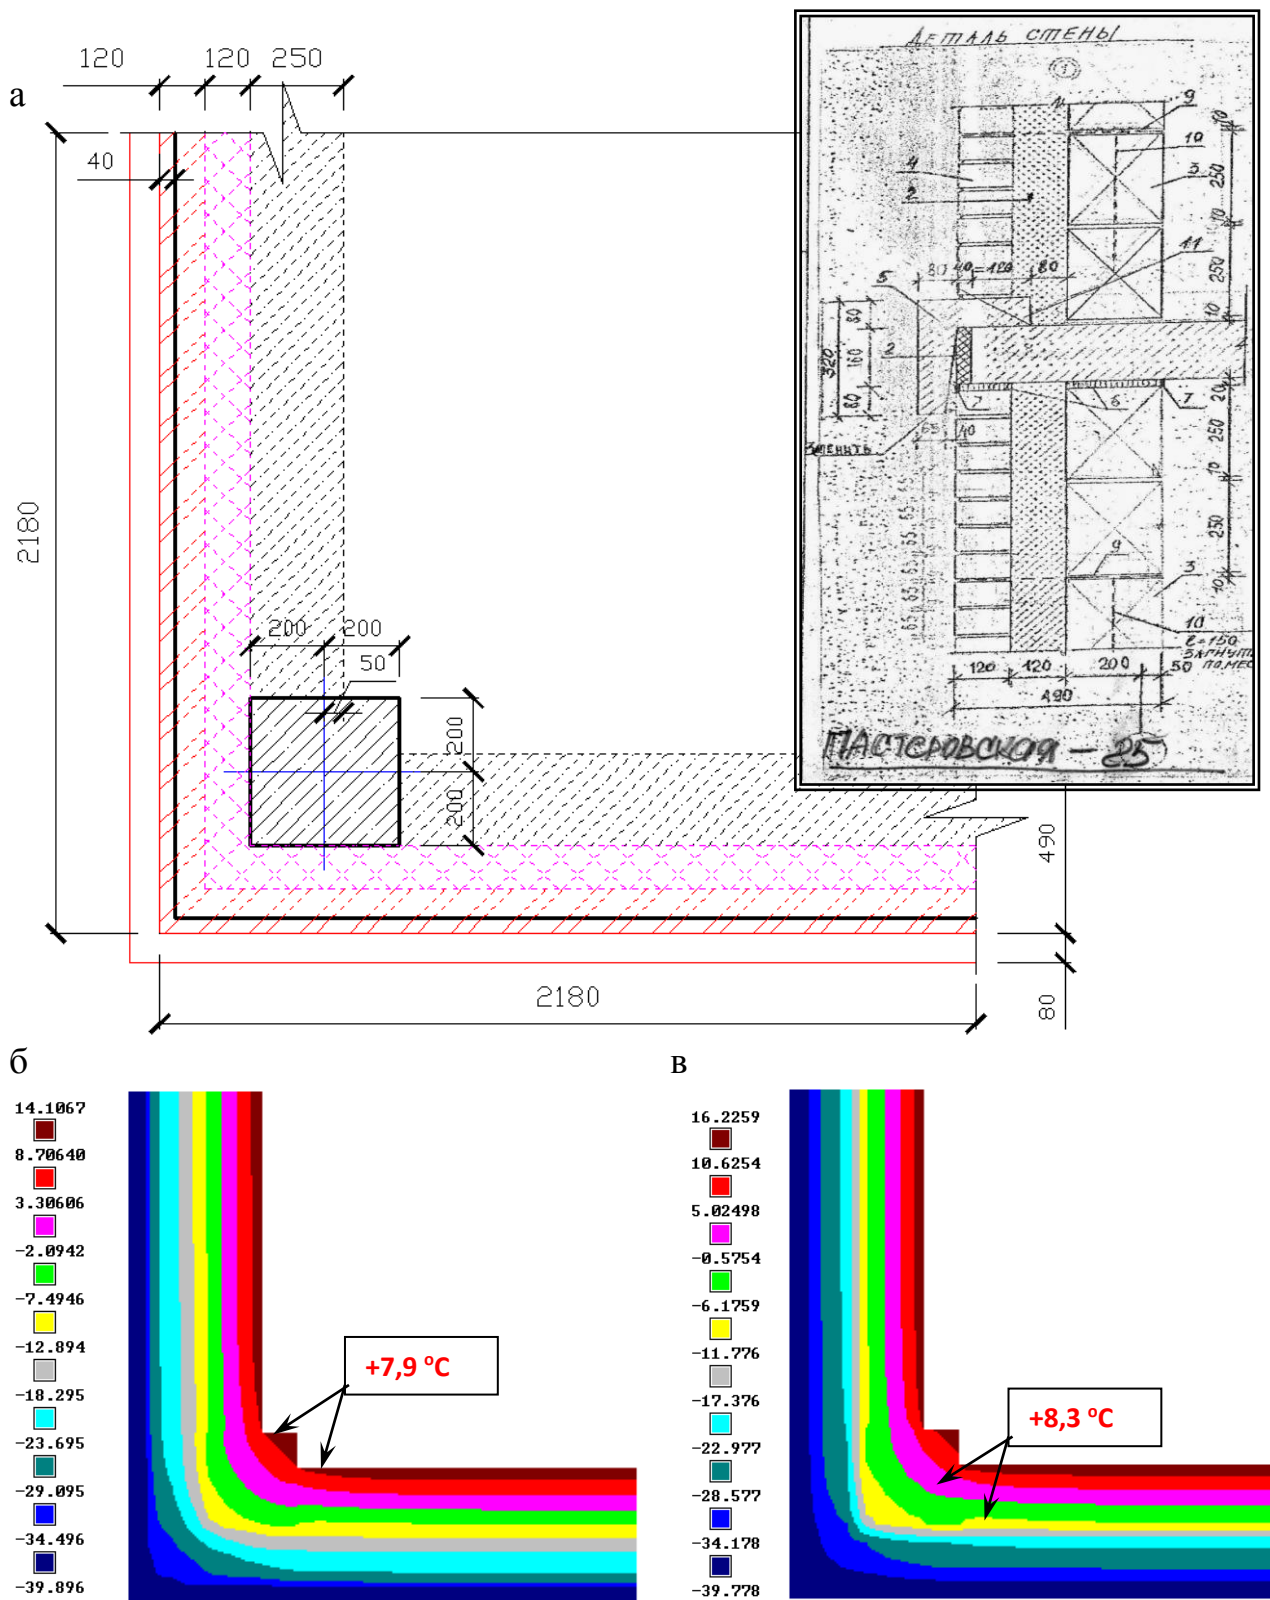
Конструктивное решение угла жилого дома № 25 по ул. Пастеровская: а – расчетная схема, б и в – изолинии по сечениям вблизи плиты перекрытия (сверху и снизу соответственно). Минимальная температура (+7,9 °С) получена в месте примыкания наружных стеновых конструкций к колонне (см. рис. 4)
